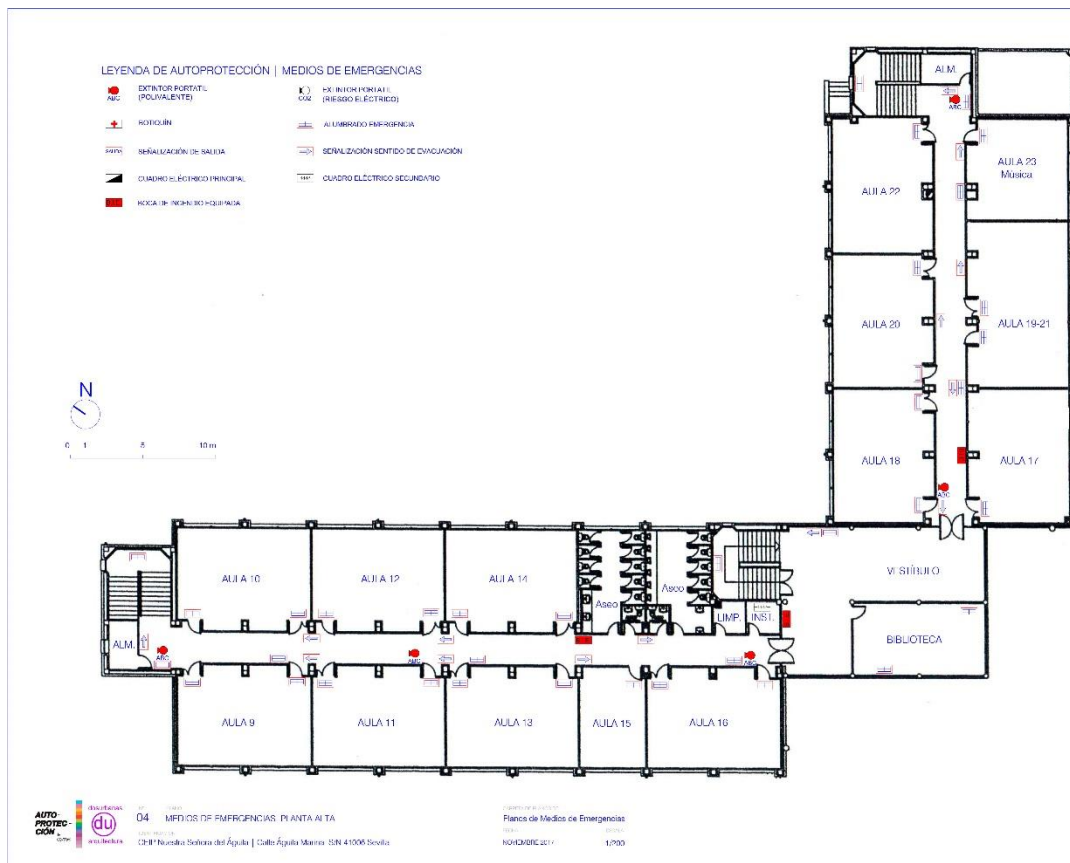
Planta primera del CEIP Ntra Sra del Águila. Planos aportados por el centro. Fuente: Autoprotección de Centros dosurbanas.com
